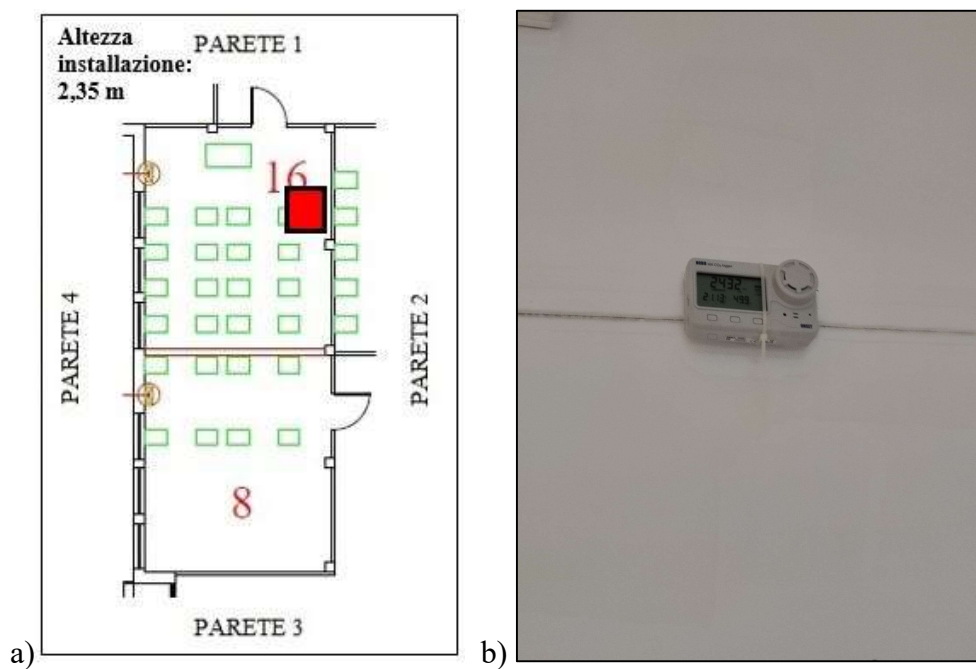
Posizione acquisitore in pianta (a) e in foto (b) Aula 8-16 (Mensa)
